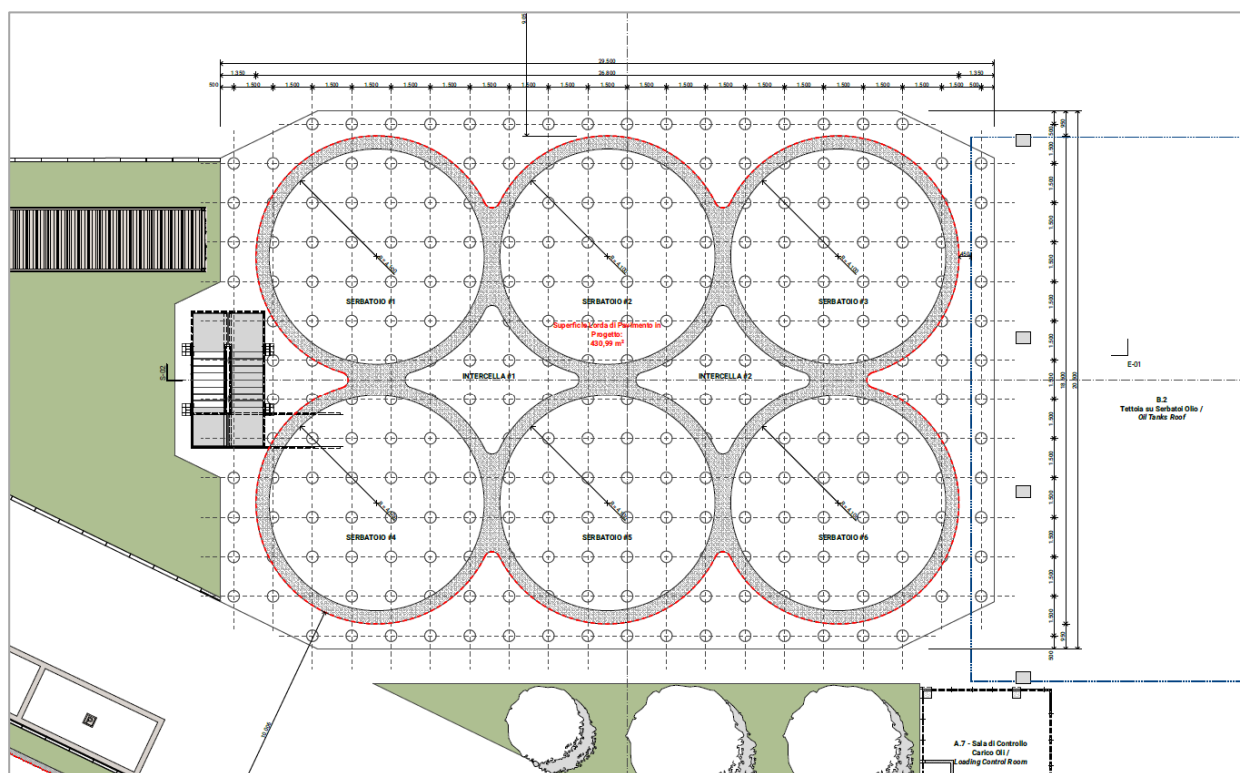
Pianta dei n. 6 nuovi serbatoi di stoccaggio oli vegetali
